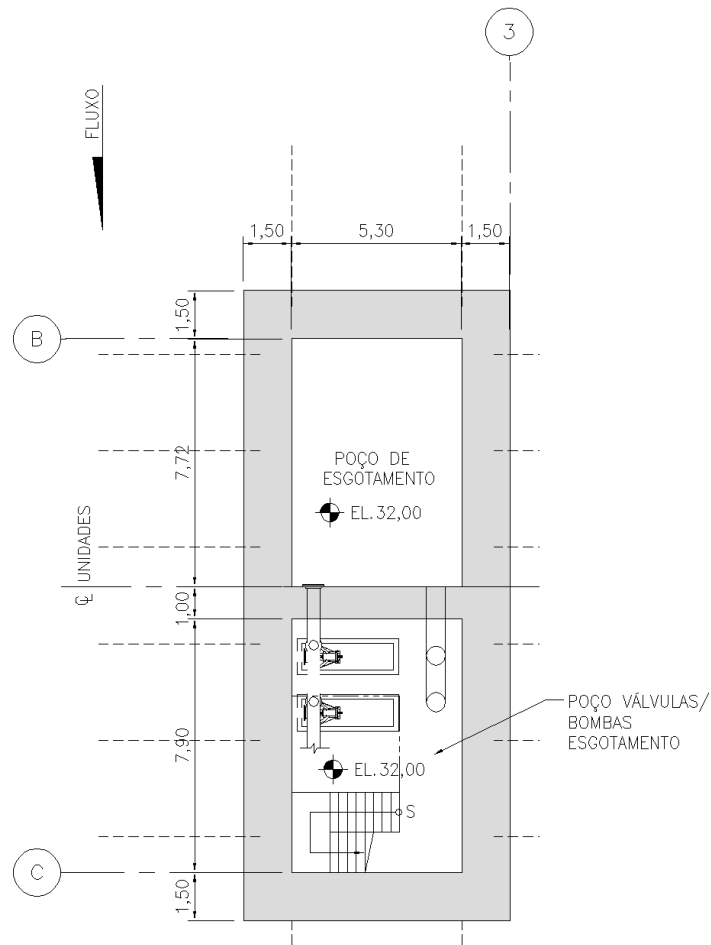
Planta EL.32,00 (Bloco lateral)
